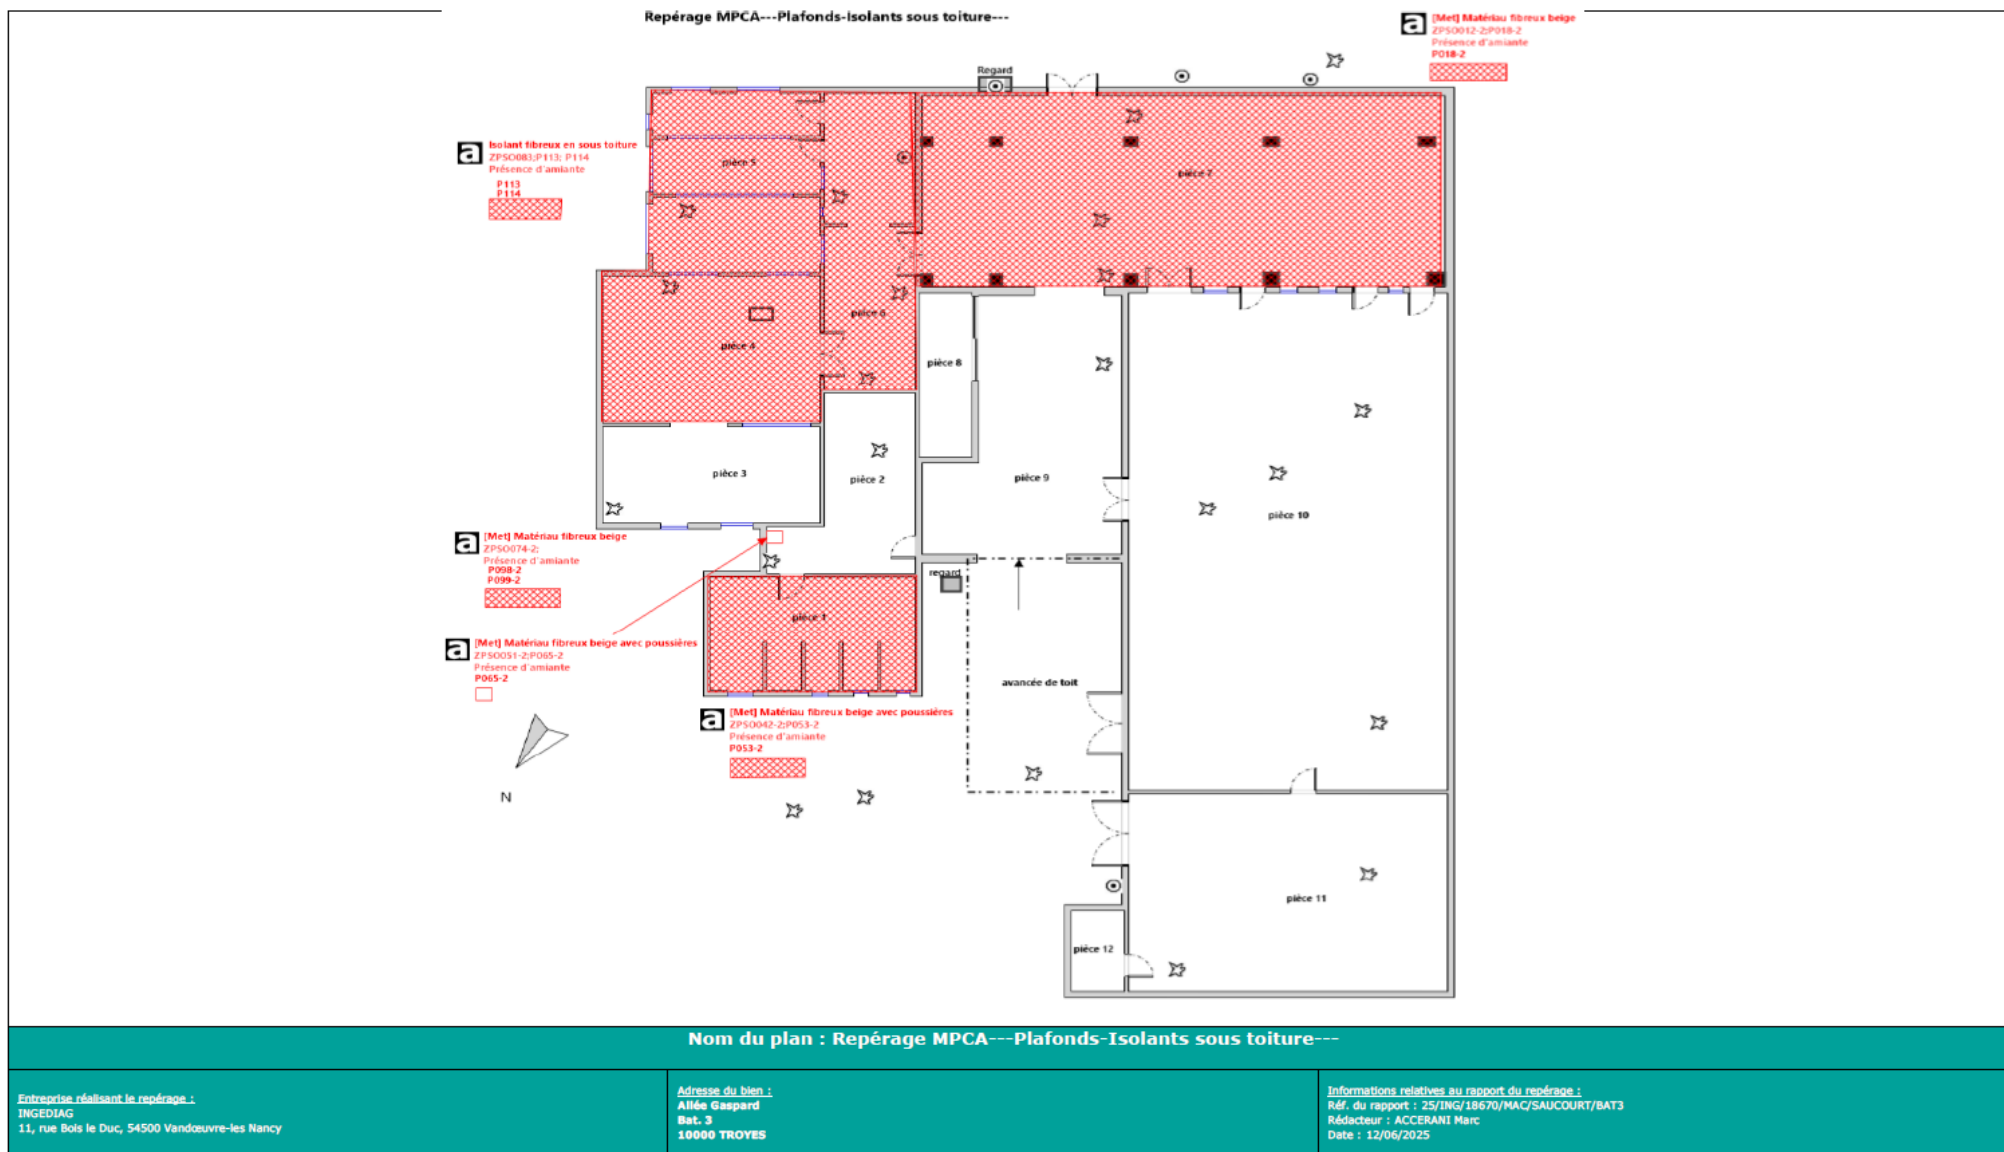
Plan des prélèvements au niveau des plafonds isolants sous toitures contenant de l'amiante dans le bâtiment 3
